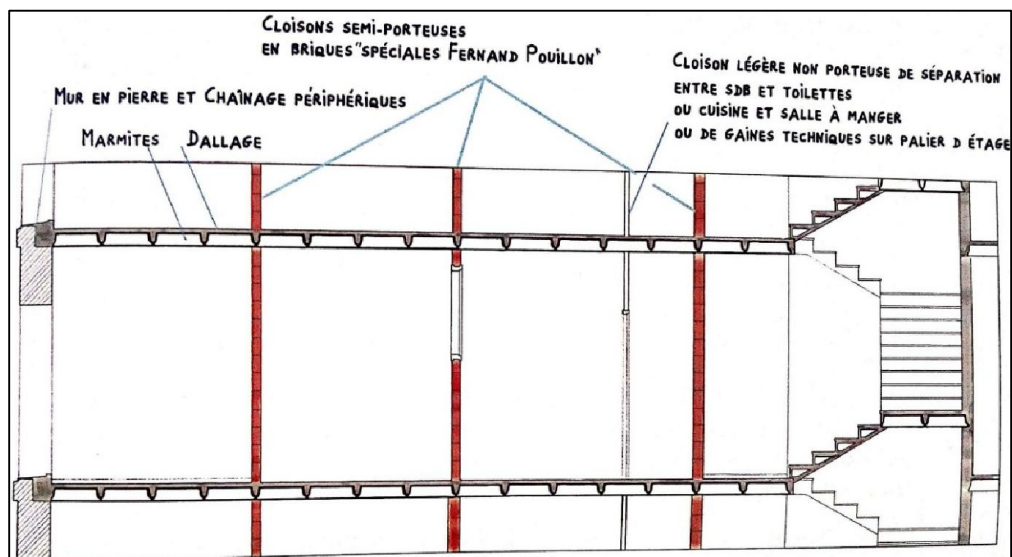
17 : Coupe qui montre le système constructif de Pouillon
